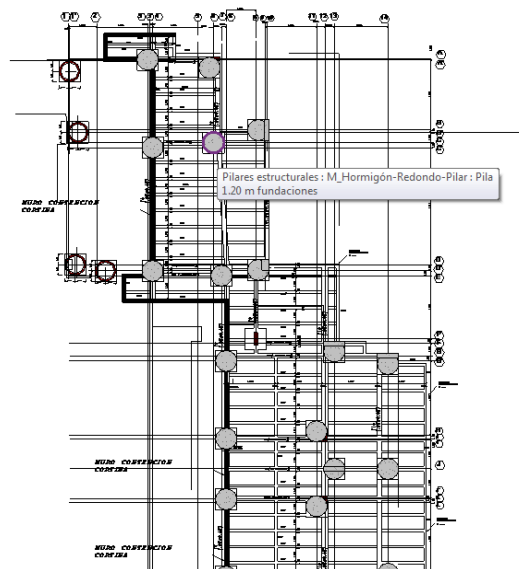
Ubicación de pilas con la ayuda del plano de fundaciones
